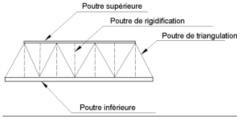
Poutres En Treillis source (https://fr.made-inchina.com/co_horizonform/product_Concrete-Column-Formwork-Rectangular-Wall-Formwork_esreriehy.html s.d.)
